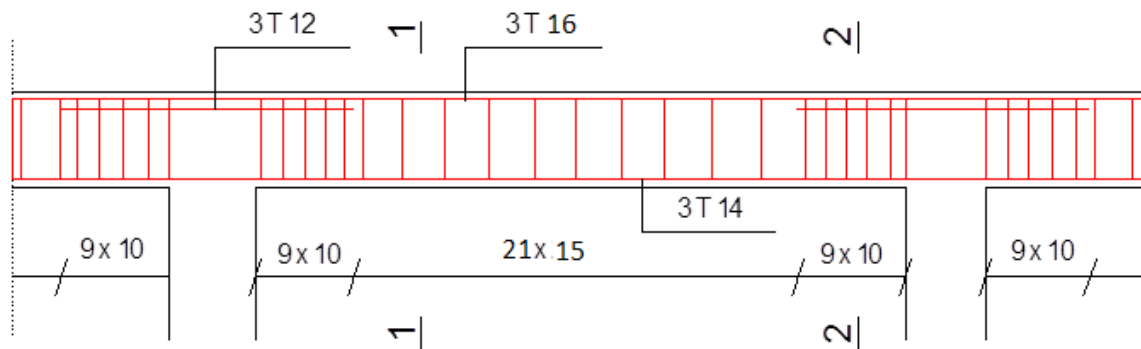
Schéma de ferrailage des poutres de chaînage.
